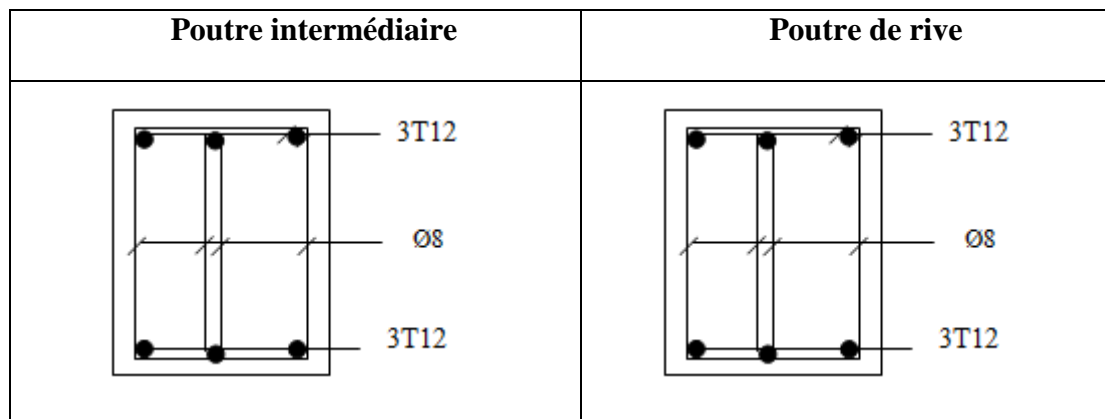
Dessin de ferrailage des sections des poutres secondaires
